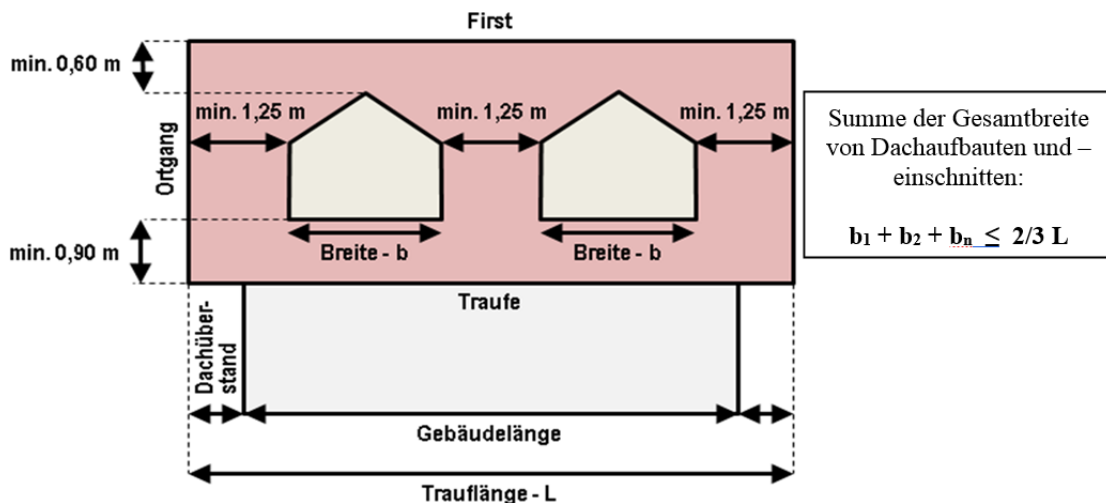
Abmessungen zulässiger Dachgauben (hier Beispiel: Sattelgaube)
